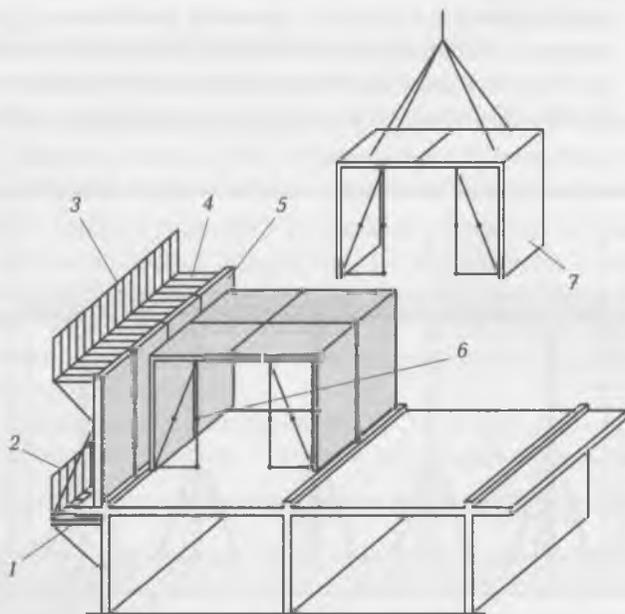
Схема установки щитов объемно-переставной (туннельной) опалубки:
